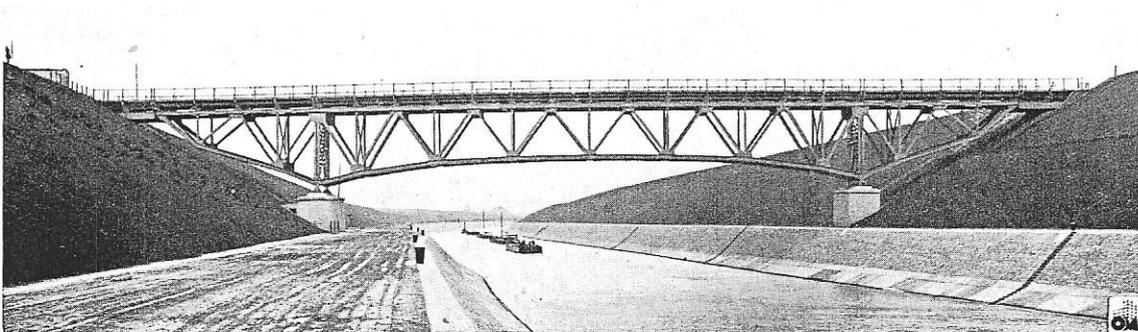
Pont de Veldwezelt à poutres principales sous chaussée.
